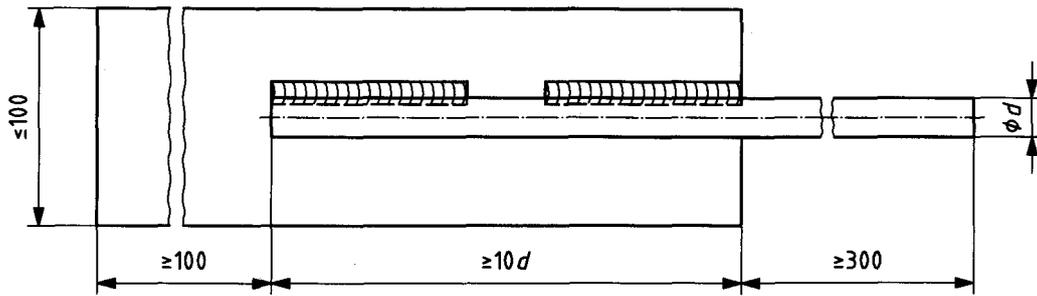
Probe für Zugversuch für andere Verbindungen (einseitige Flankenkehlnähte)
